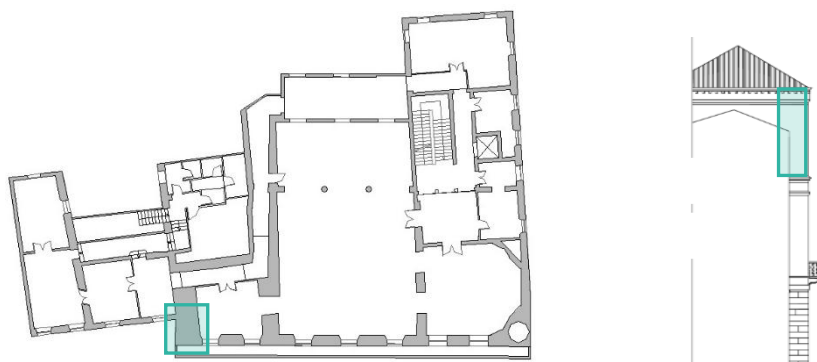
Individuazione macroelemento, pianta e prospetto
